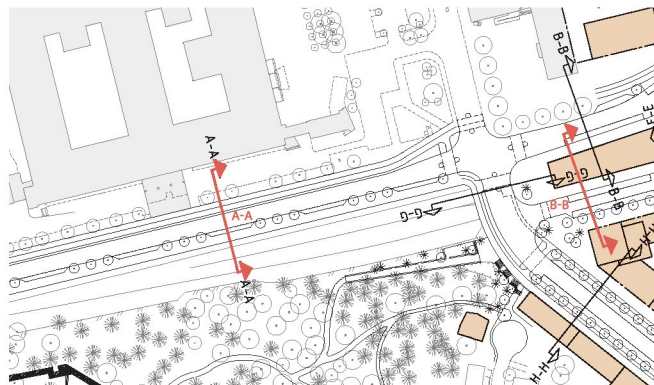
Föreslagen utformning av gatunätet i plan med sektionsmarkeringar
